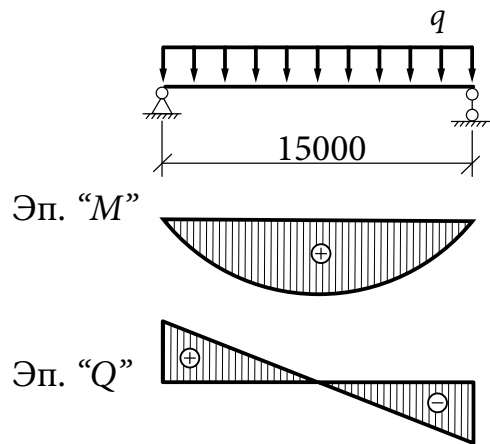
Расчетная схема и эпюры внутренних усилий
